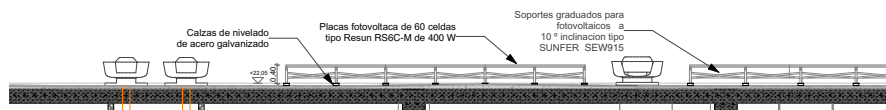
Sección 2 arquitectónica de paneles solares (Zalamea, 2021)
